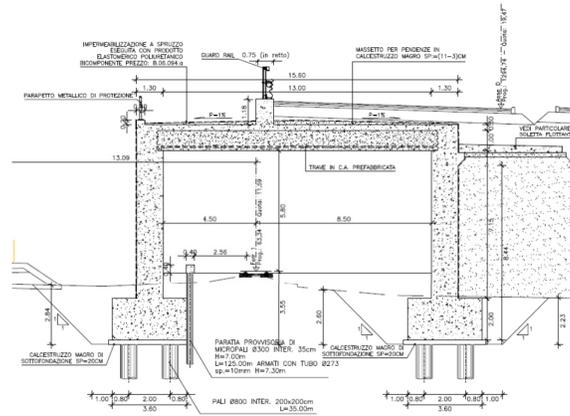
Planimetria - Galleria artificiale ferroviaria "B"
